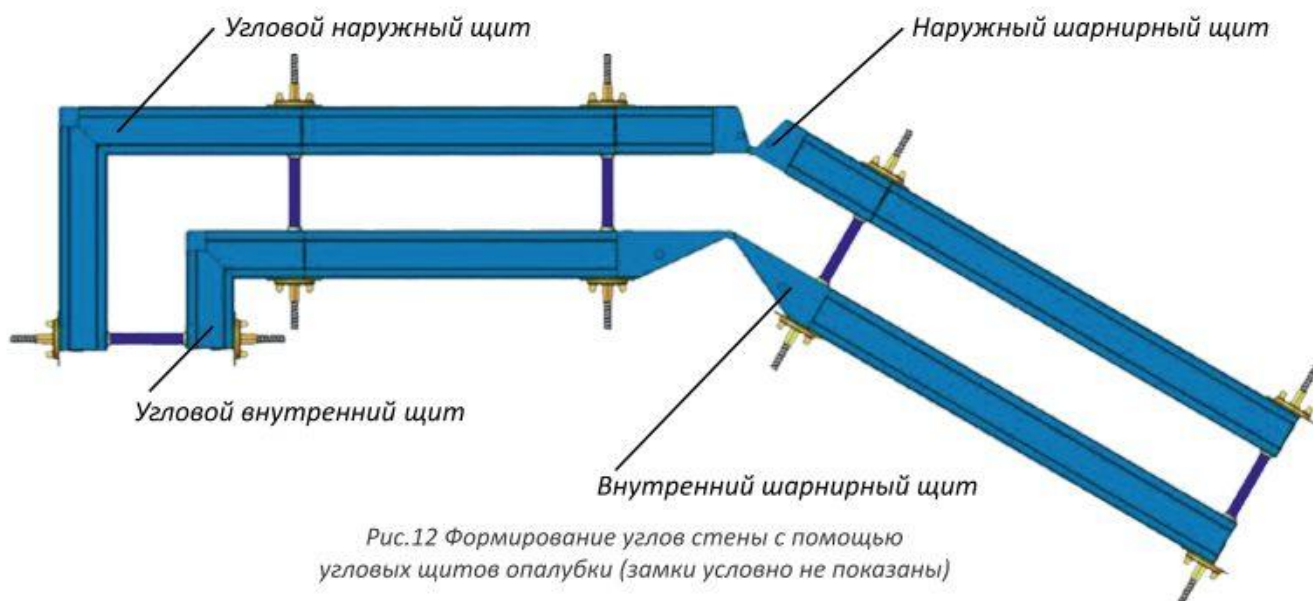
Формирование углов стены с помощью угловых щитов опалубки (замки условно не показаны)
